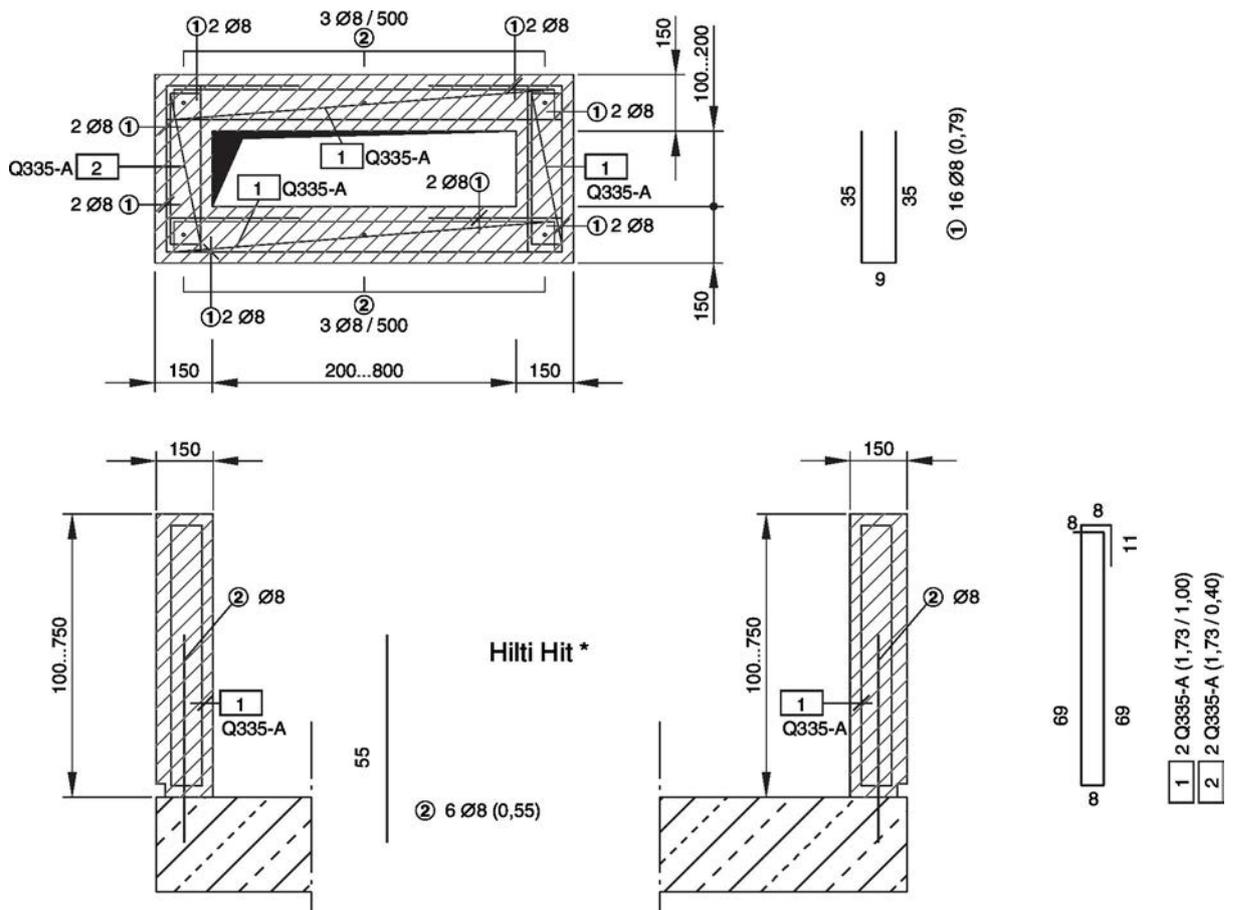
Bewehrungsplan Betonsockel, Höhe 100 - 750 mm
